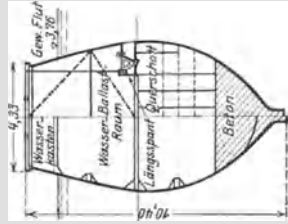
Verschlussponton, veraltete Form. Binnenhaupt. I. Einfahrt Wilhelmshaven. Maßstab 1 : 800.
